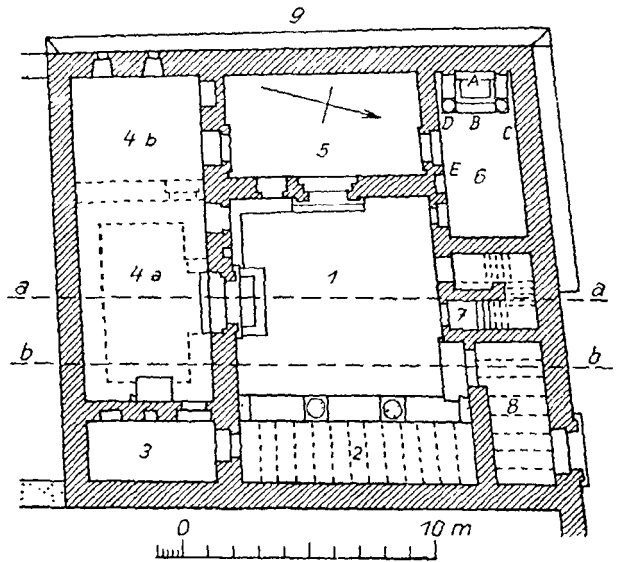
Dura, Christliches Gemeindezentrum, Grundriß (nach v. Gerkan). 1 Offener Hof. 2 Vorhalle. 3 Nebenraum. 4 Diwan (mit Bänken). 5 Saal. 6 Kultraum (mit Taufbecken u. Ziborium). 7 Treppenanlage. 8 Eingangskorridor. 9 Wallgasse. – *a-a* Erste Lehmziegelböschung. *b-b* Zweite Böschung. – *A* Adam u. Eva, Hirtenbild (Rückwand unter Ziborium). *B* Guirlandenornament am Ziboriumsbogen. *C* Obere Zone: Heilung des Gichtbrüchigen, Wandel Jesu auf dem Meere; untere Zone: Frauen am Grabe (?). *D* David u. Goliath. *E* Samariterin am Brunnen.
